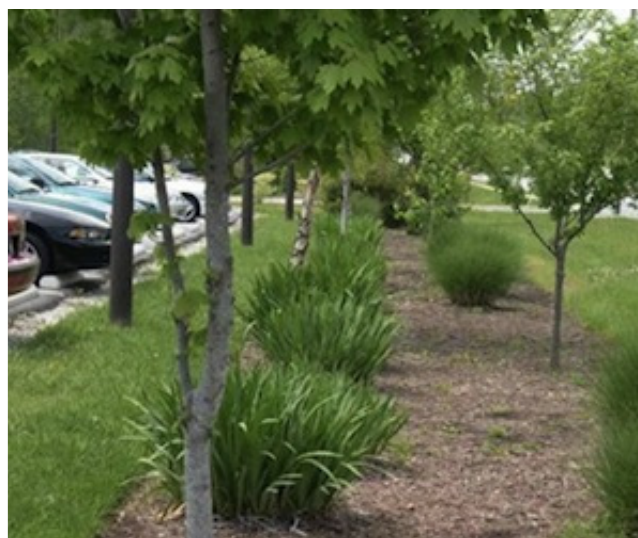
Faixa filtrante entre estacionamento e trincheira de infiltração
